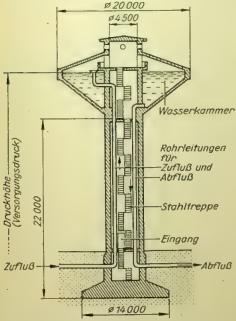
Stahlbeton-Wasserturm mit 1100 m³ Fassungsvermögen
